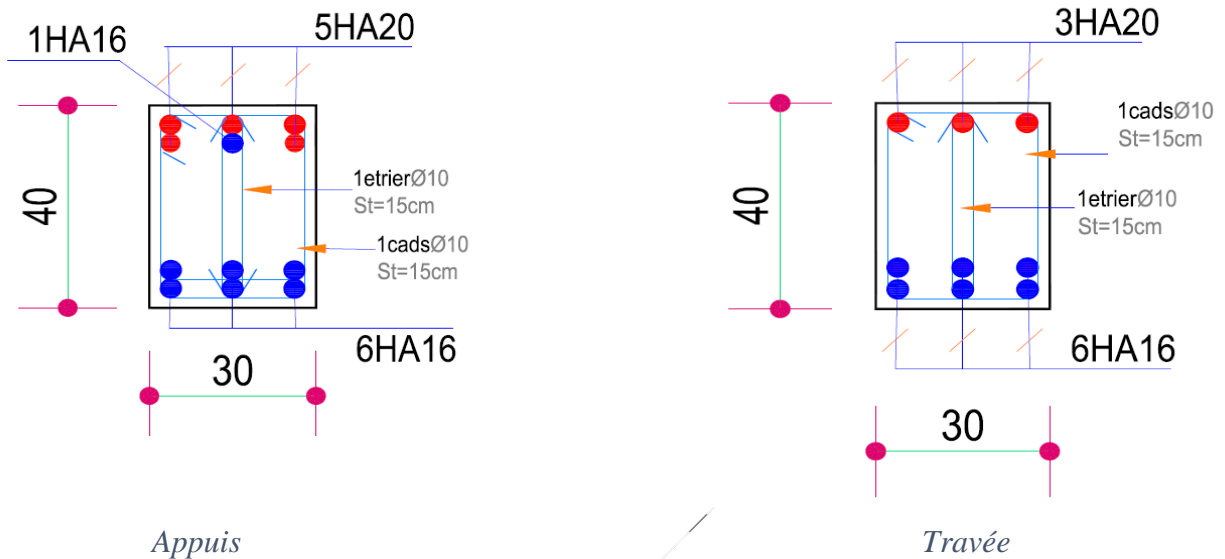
Schéma de ferrailage des poutres principales du RDC
